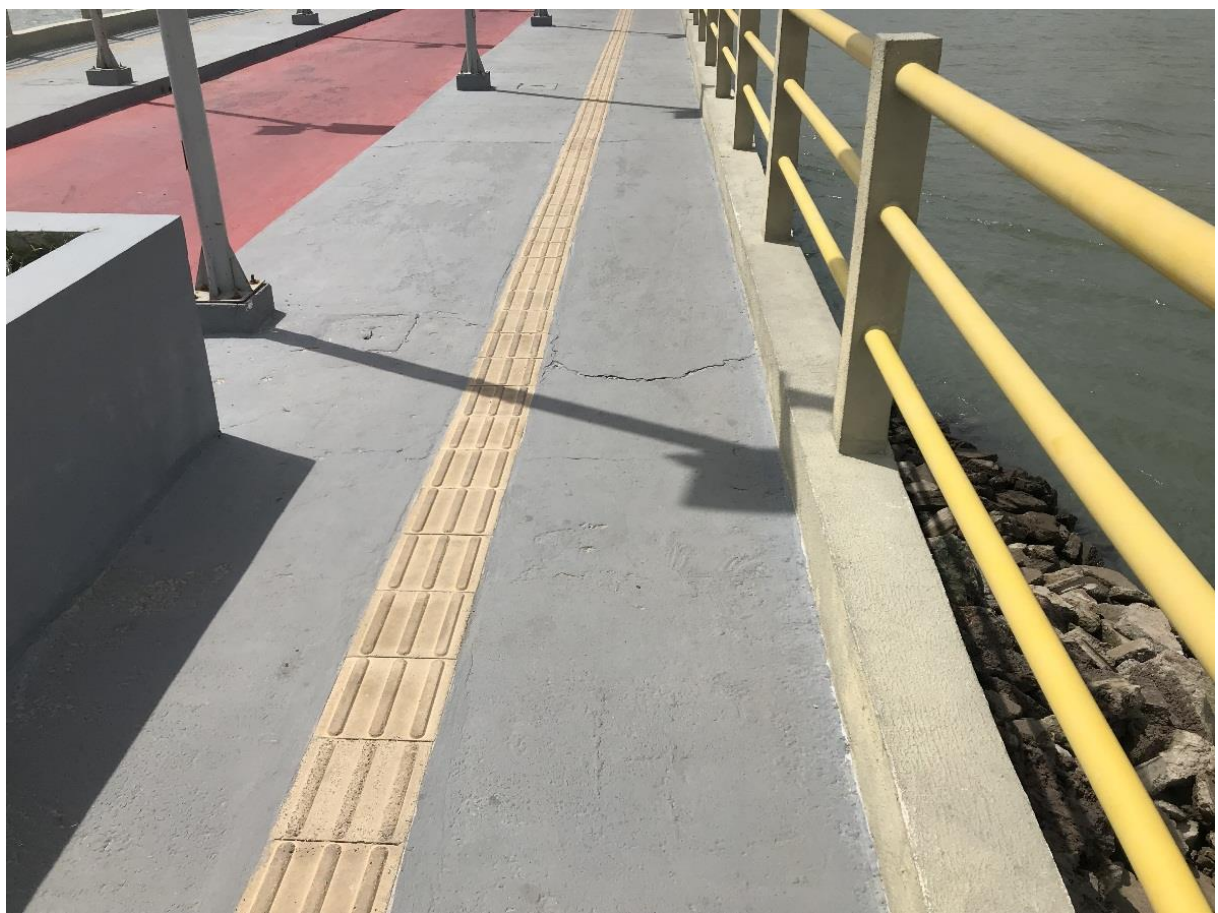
Final do trecho em aterro, início da ponte, com destaque para a fissura do piso.
